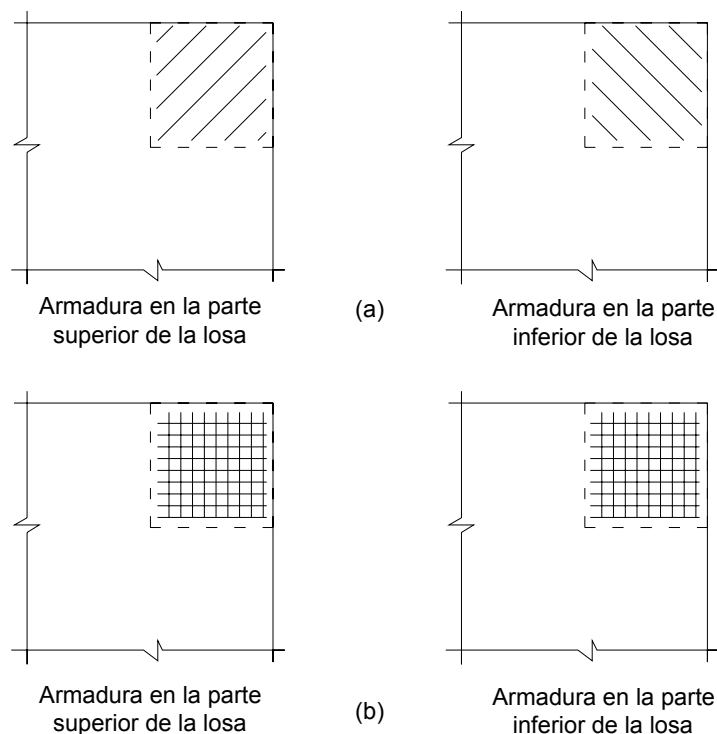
Armadura adicional requerida en las esquinas de las losas apoyadas sobre vigas
